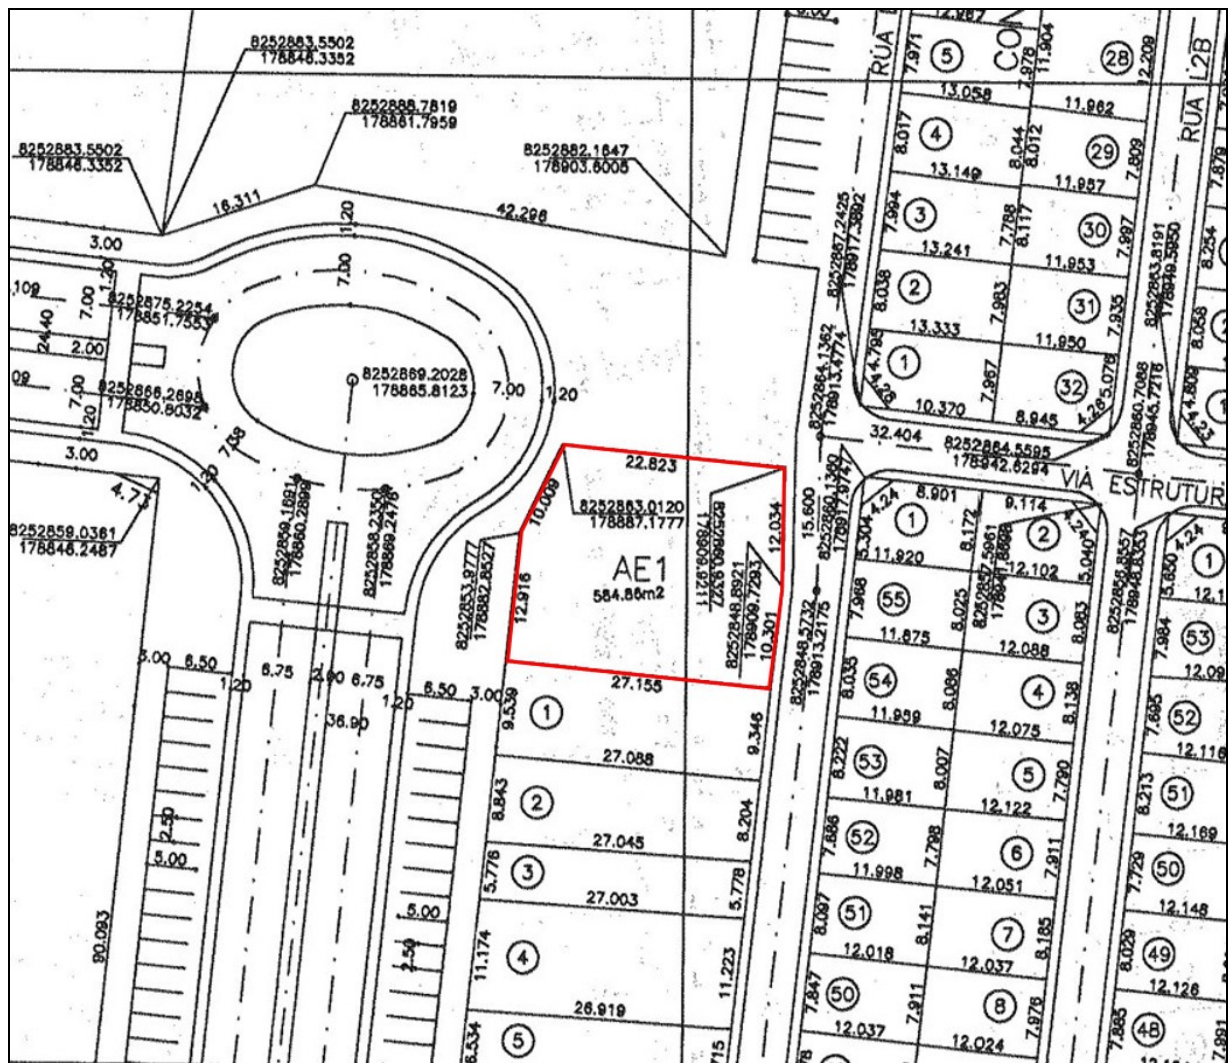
Trecho da planta SCIA URB 025/2011 com indicação da área objeto desta DIREQ.
